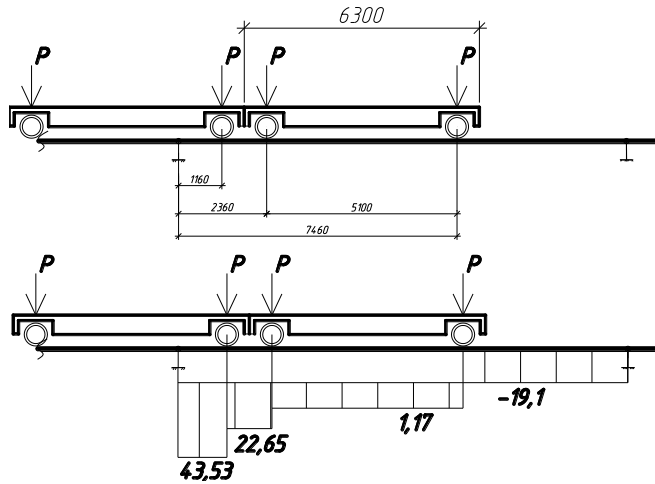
К расчету по наклонным сечениям (размерности t и $мм$).
